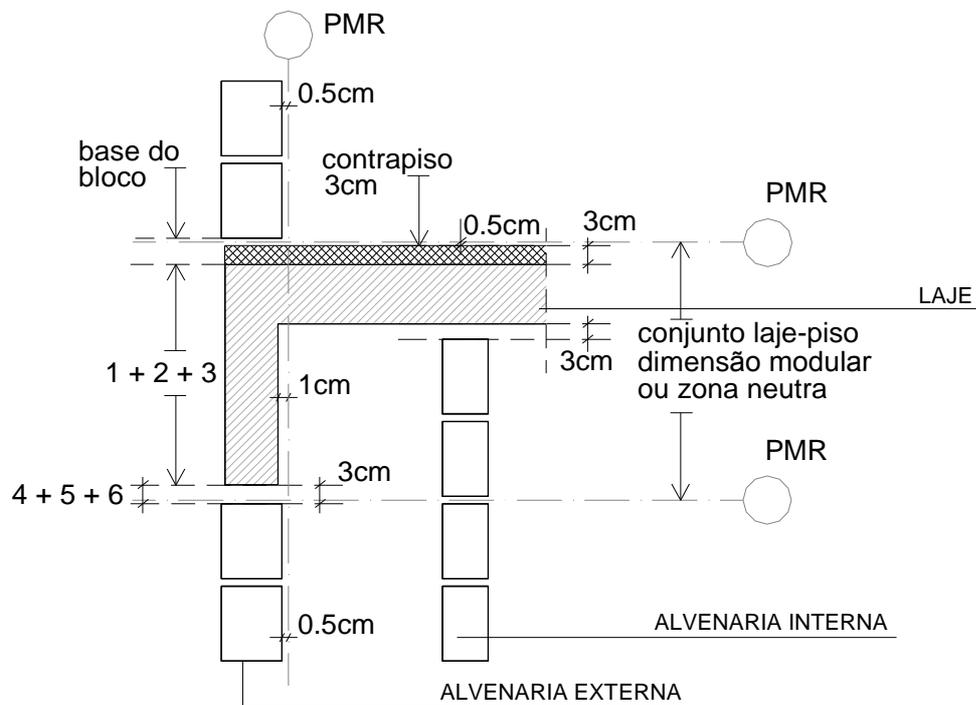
Conjunto laje-piso – corte esquemático (Adaptada de LUCINI, 2002).
